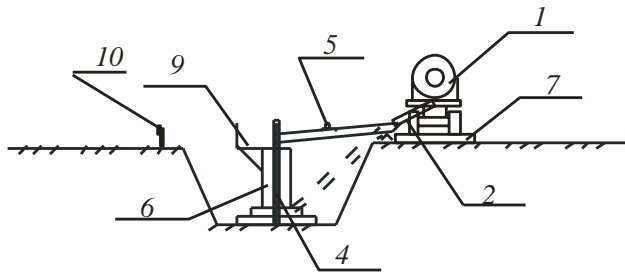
Схема бетонирования фундамента при помощи автобетоносмесителя и виброжелоба:
